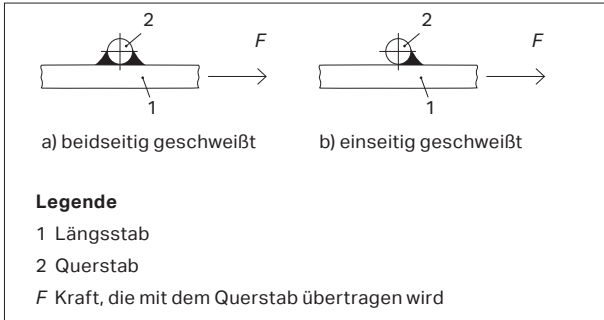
Geschweißter Kreuzungsstoß nach Kap. 6.5.2 – Bild 4
